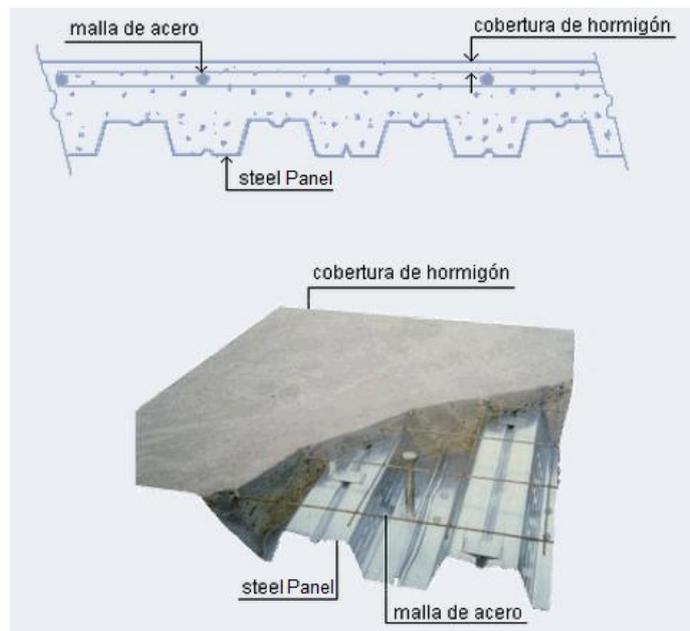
DETALLE CUBIERTA STEEL PANEL Y HORMIGÓN
